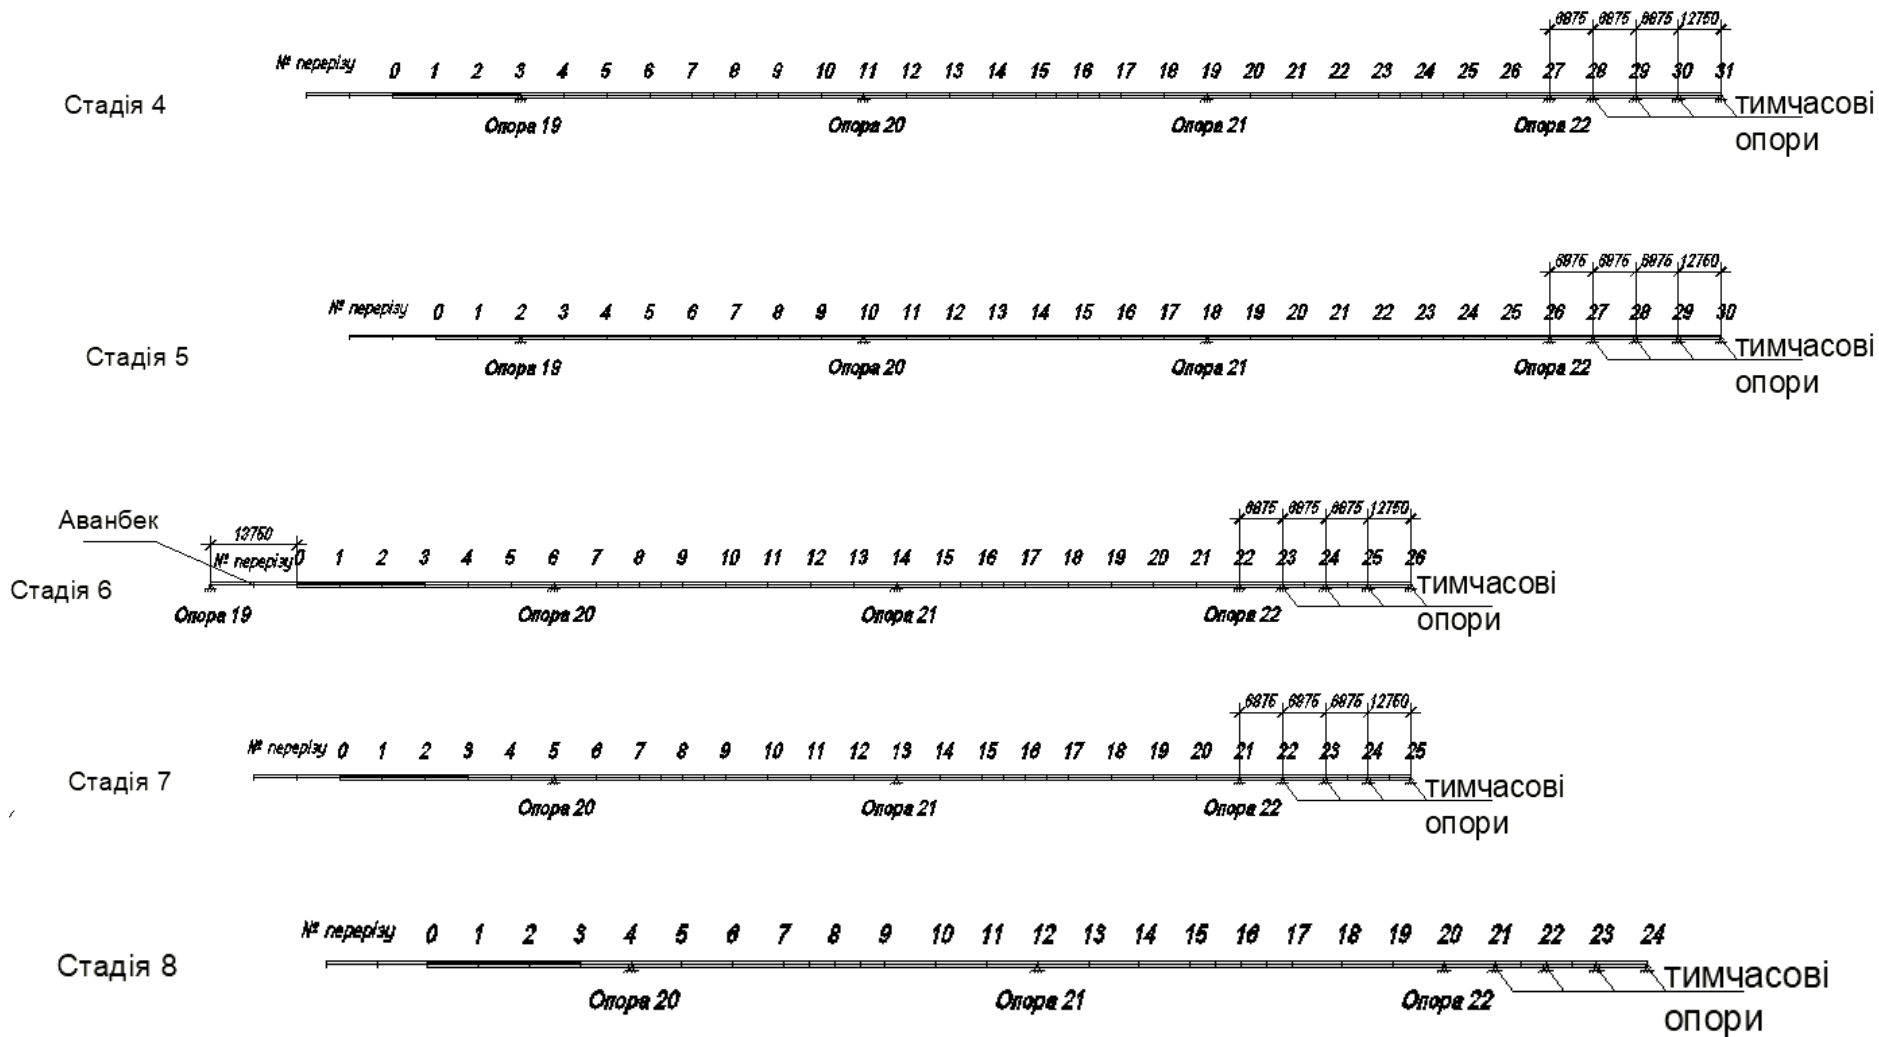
Розрахункові схеми стадій монтажу 4-8
